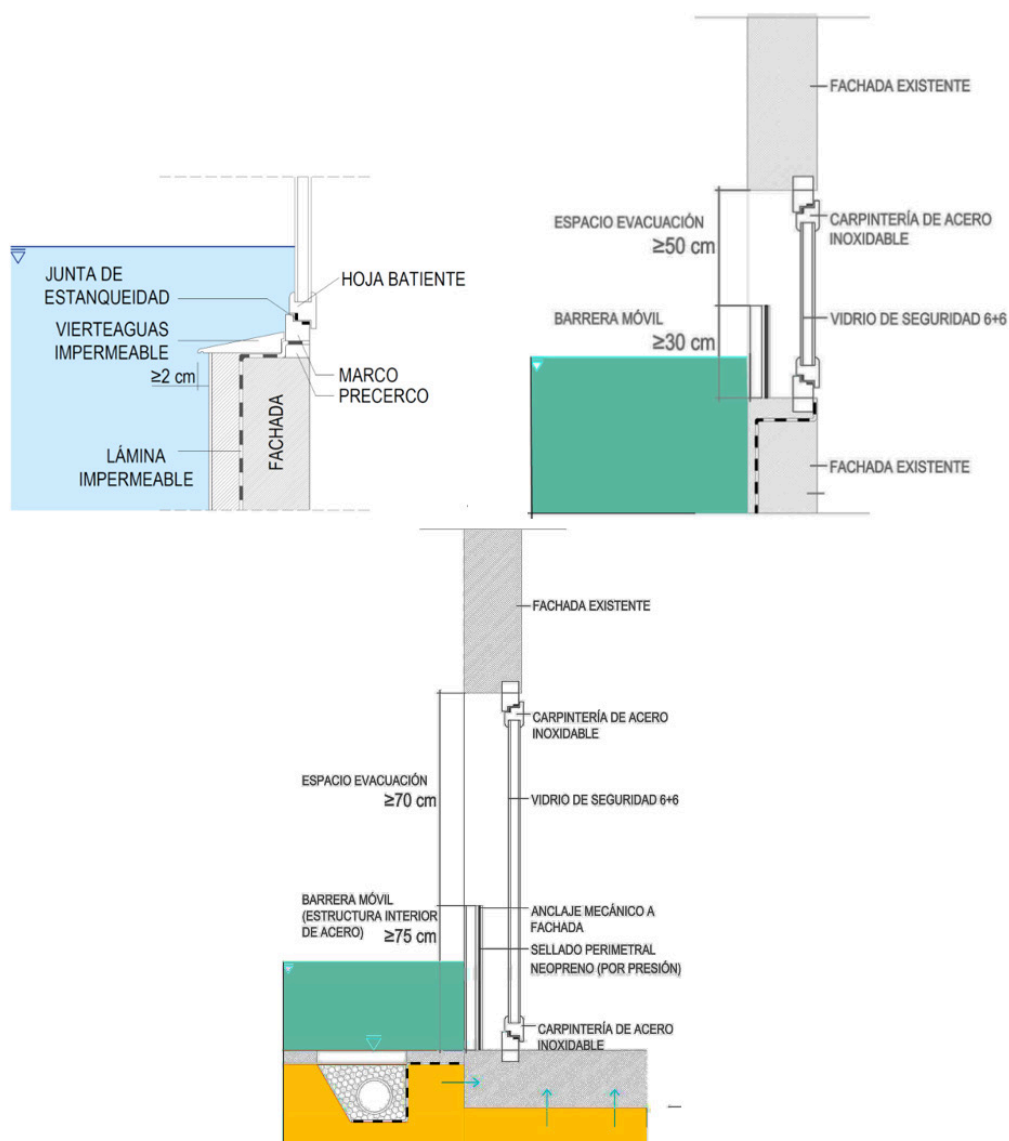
Juntas de estanqueidad en carpintería; barreras de protección móvil en ventana y escaparates.
